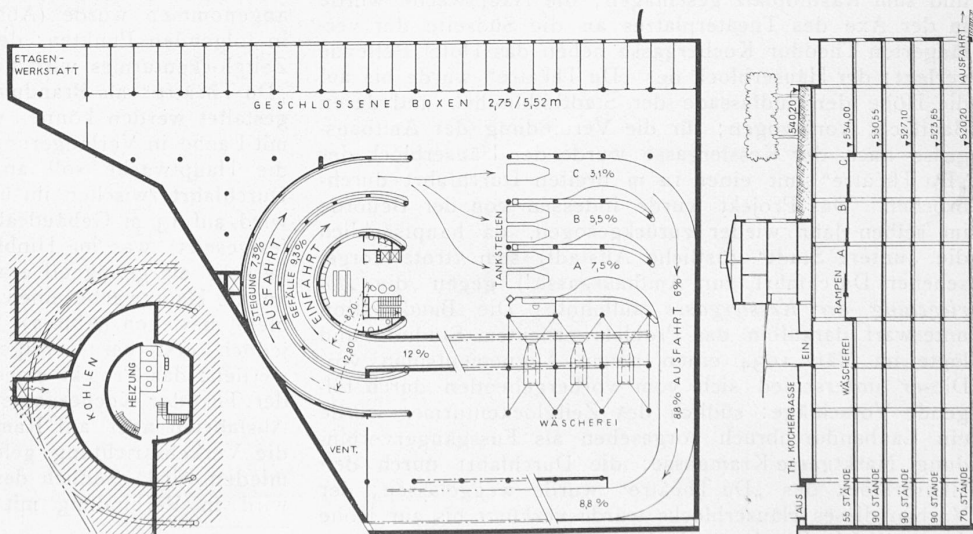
Projektierte Grossgarage auf dem Kasinoplatz. — Entwurf von Arch. W. v. Gunten (Bern). Grundriss vom 1. und 6. Untergeschoss, rechts Querschnitt. — Masstab 1 : 800.
